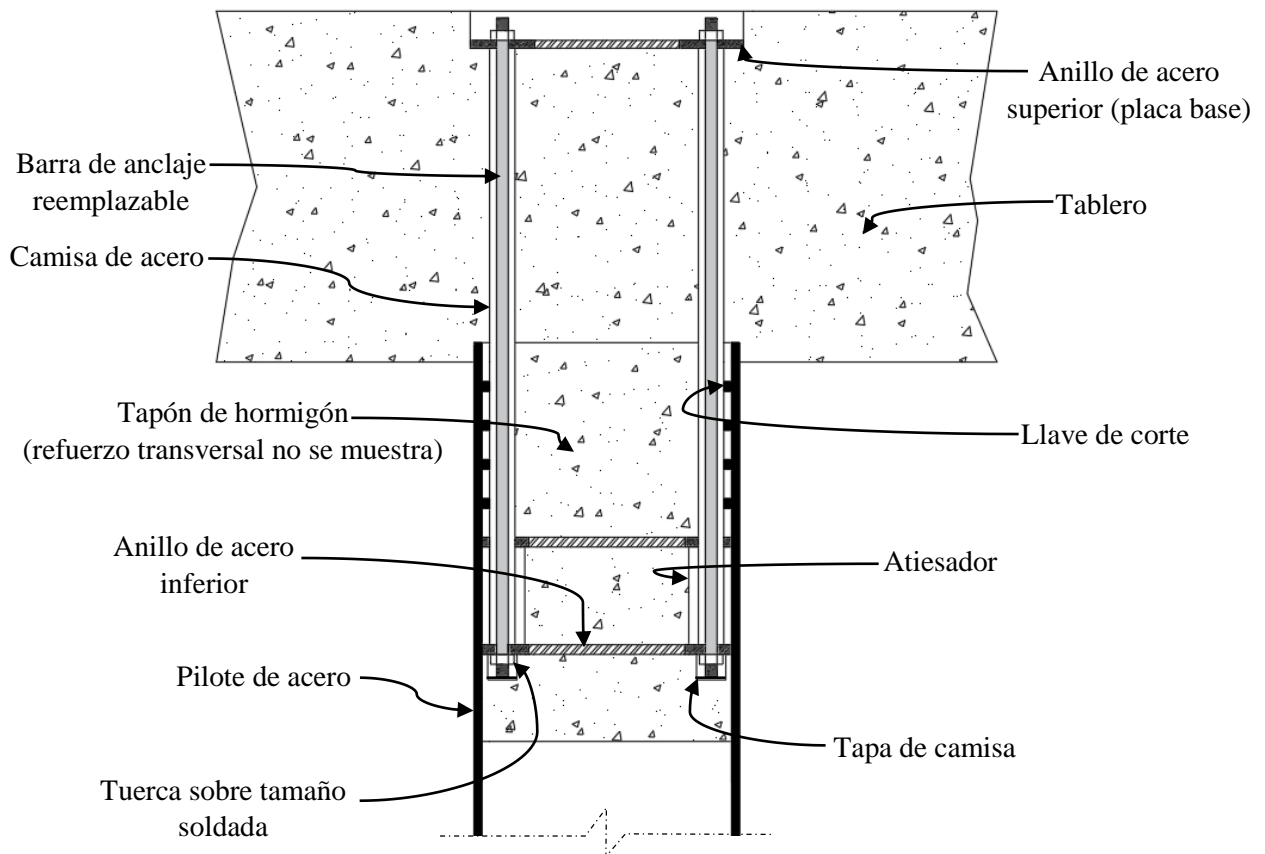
Elementos principales del sistema de conexión con barras de anclaje reemplazables.
